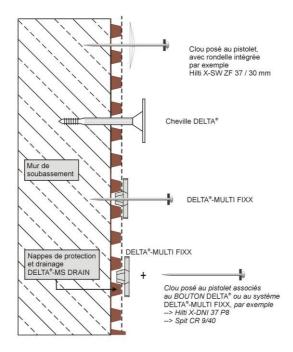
Procédés de fixation haute des NEPE de protection et drainage DELTA-NP DRAIN et DELTA-TERRAXX sans revêtement d'étanchéité
